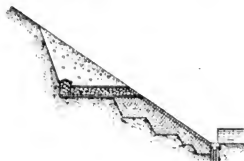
Gemauerte Sickerdohle mit Abzugkanal. M. 1 : 200.
